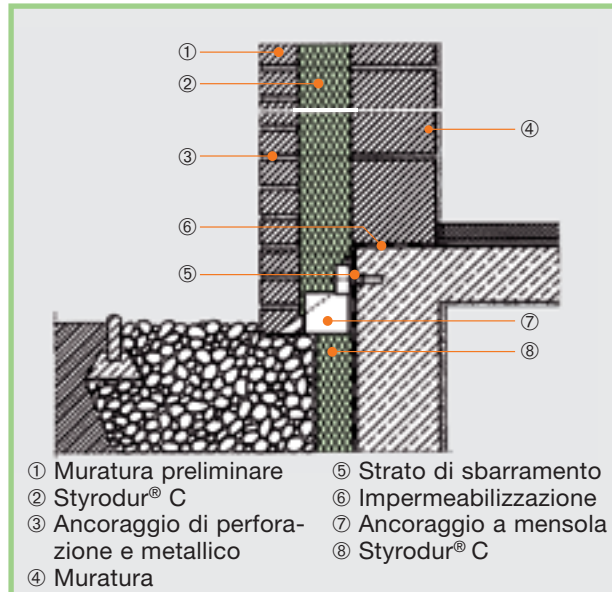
Collegamento dell'isolamento perimetrale alla muratura con isolamento in intercapedine e ancoraggio a mensola.
